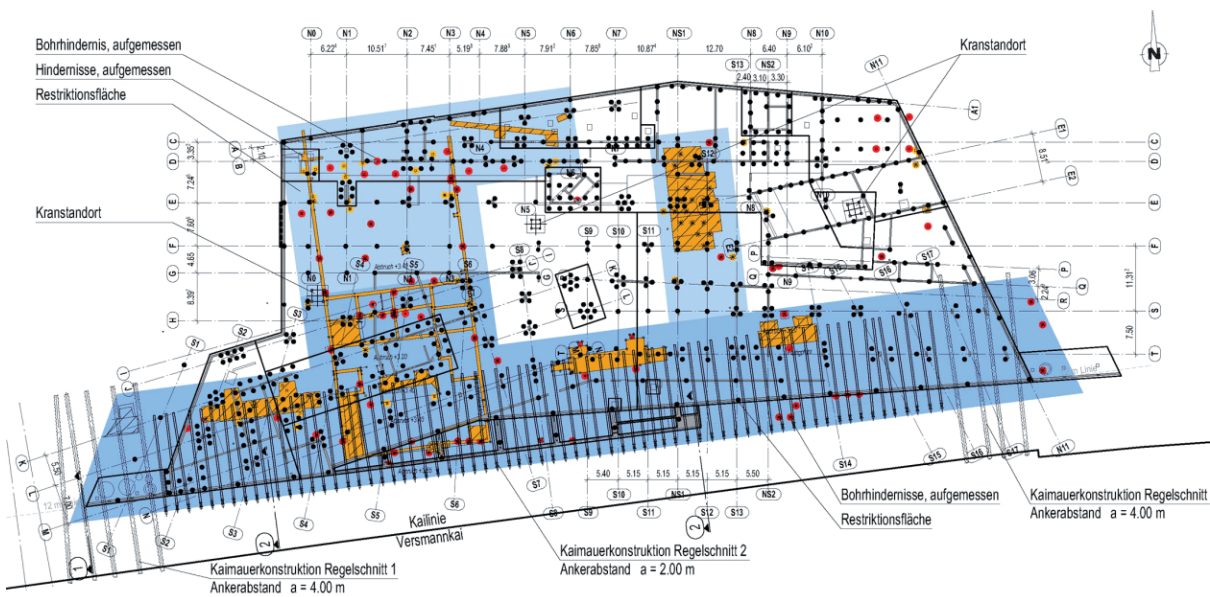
Pfahlplan mit Darstellung der Restriktionsflächen
